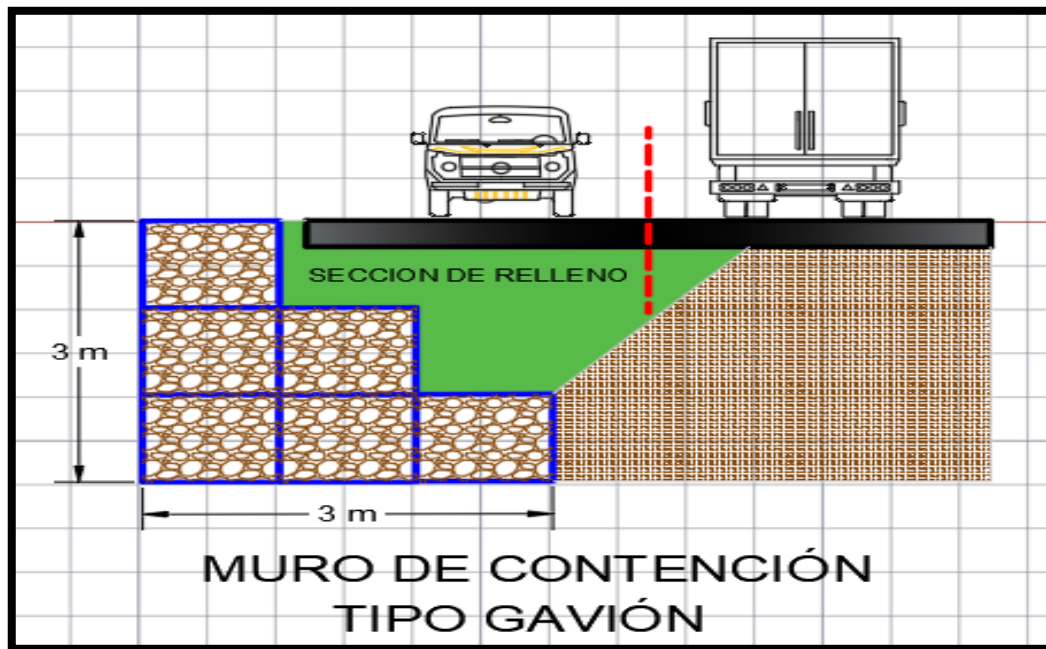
Dimensión propuesta y forma de cómo trabaja del muro de contención tipo gavión.
